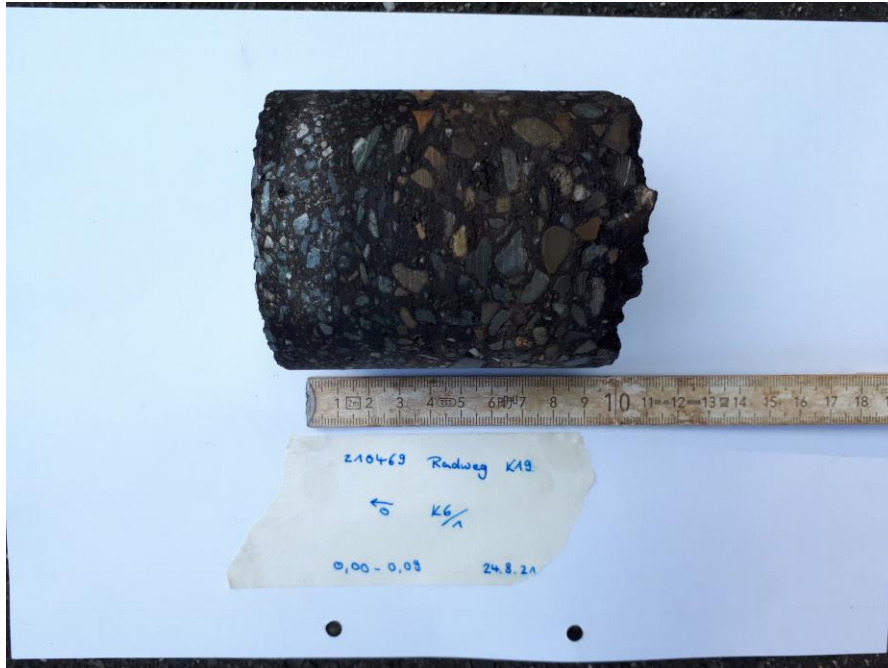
Detailfoto Kern K6/1 (0,00-0,09 m)
